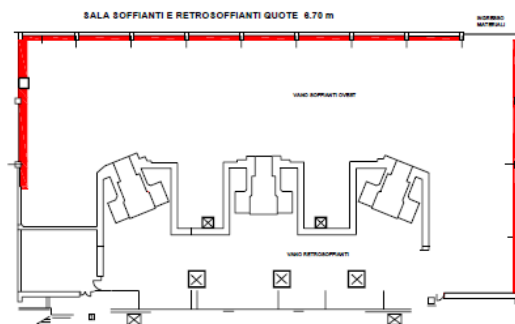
Planimetria Edificio Reattore quota 6,70 m s.l.m.m - strutture portanti di rinforzo strutturale
